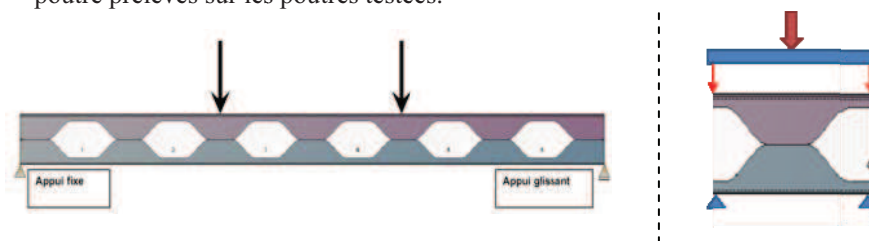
Poutre originelle (a) Echantillon de poutre découpé (b).
